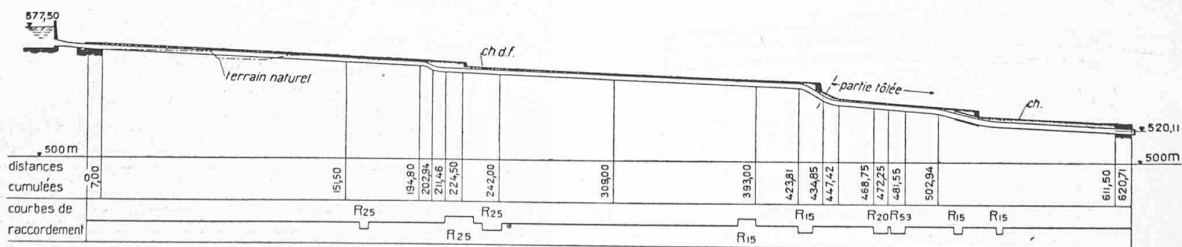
Profil en long de la conduite en béton armé. Pression statique max. 55,14 m. — Echelle des longueurs et des hauteurs 1:4000.
